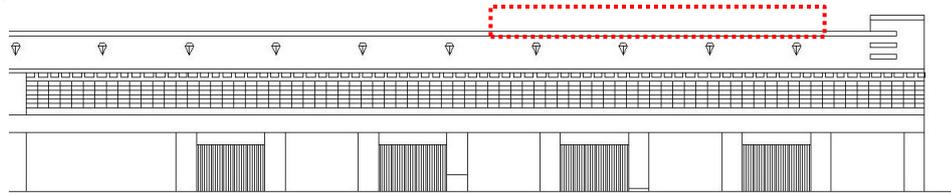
Elemen Bukaan pada Fasad Toko 1 lantai
